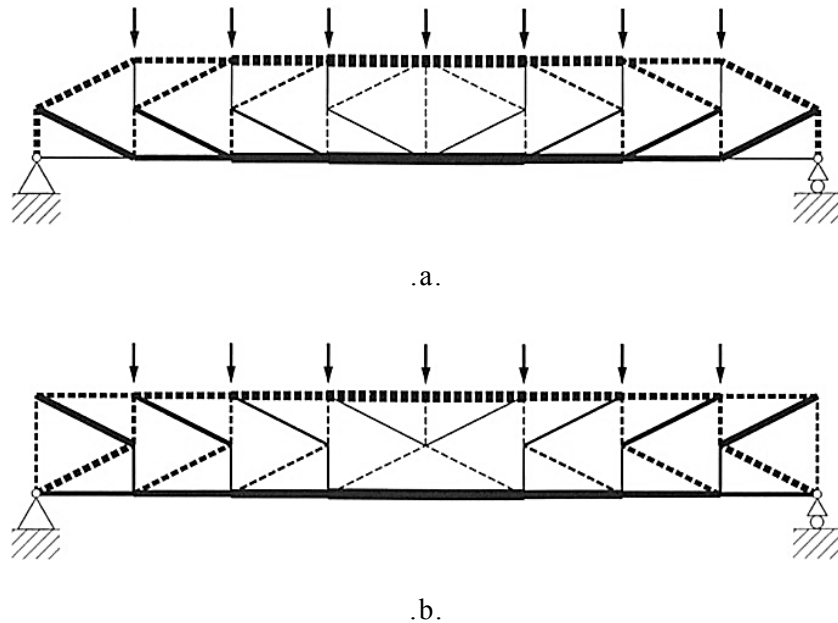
a) Viga “en K” con orientación de las diagonales similar a la forma de la estructura arco-tirante, b) Viga “en K” con orientación invertida de las diagonales con respecto a la estructura arco-tirante. (Imagen tomada de (Muttoni 2011, 144)).
